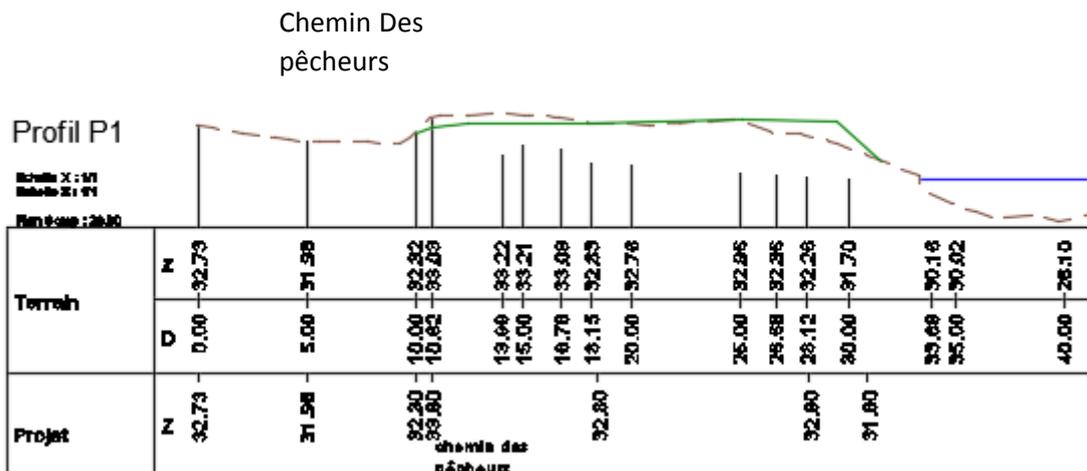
Profil en travers P1 au niveau de l'entrée du site
